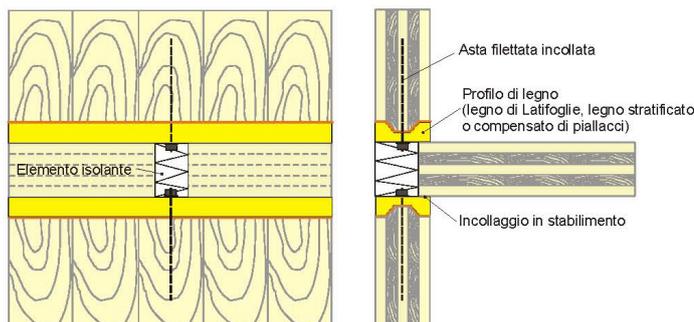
Giunzione parete-solaio-parete, esempi rappresentativi della realizzazione della connessione
